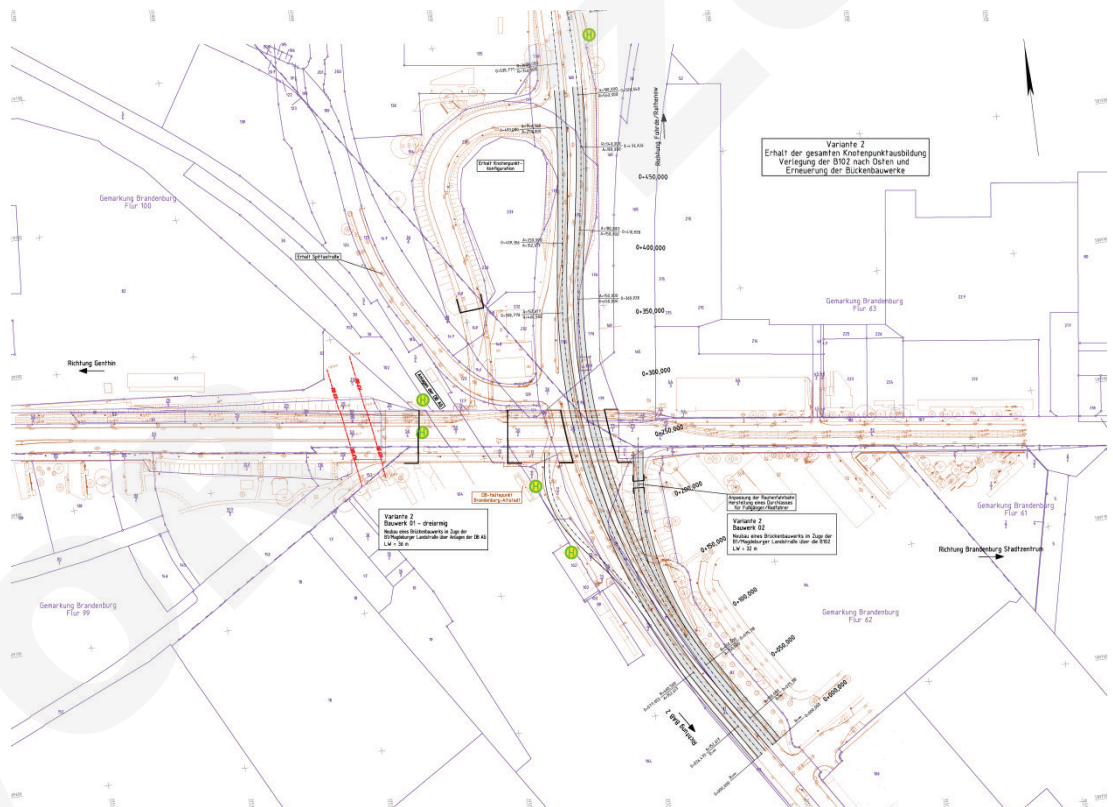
Lageplan, Knotenpunkt B1 / B102, Variante 2²
